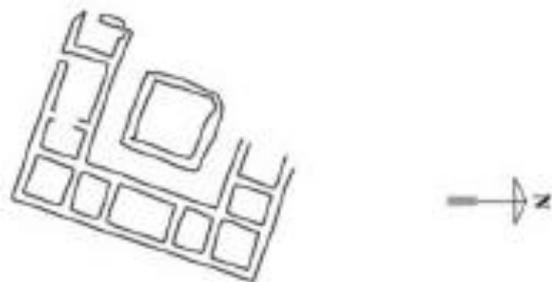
Planta del edificio hallado en el Kom B de Awlib (BALDI 2014: fig.1).
